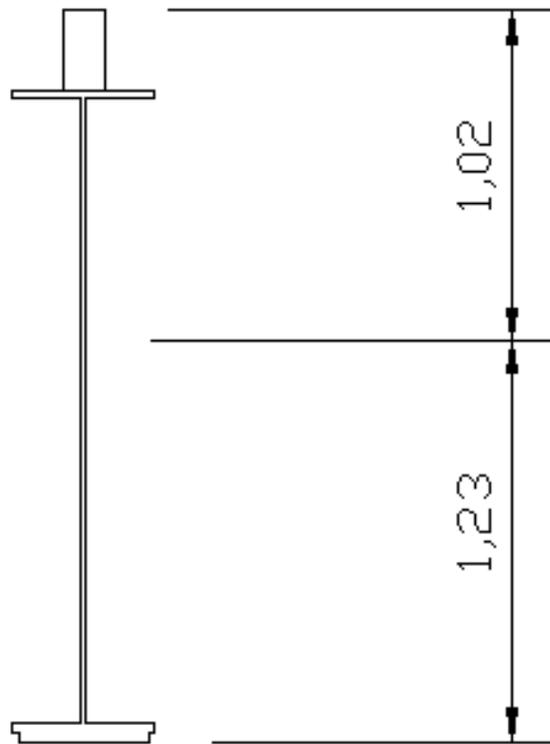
Diseño de viga metálica con losa colaborante. Sección viga en etapa de Terminación. Con sección transformada de H.A a acero.
